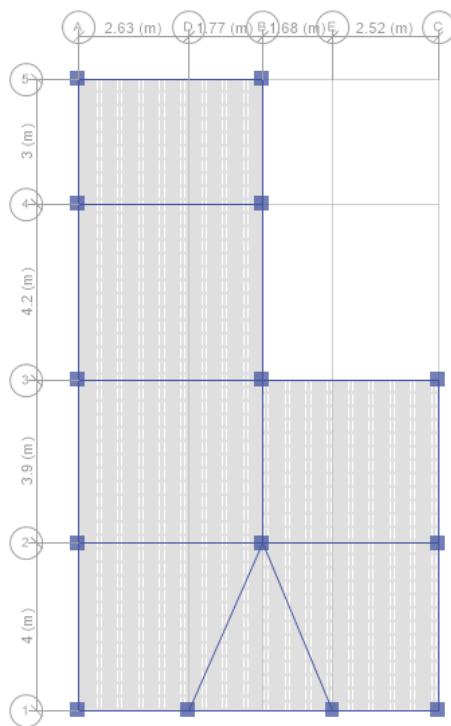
Configuración en planta de la alternativa 1 (Macias y Quezada, 2019)
